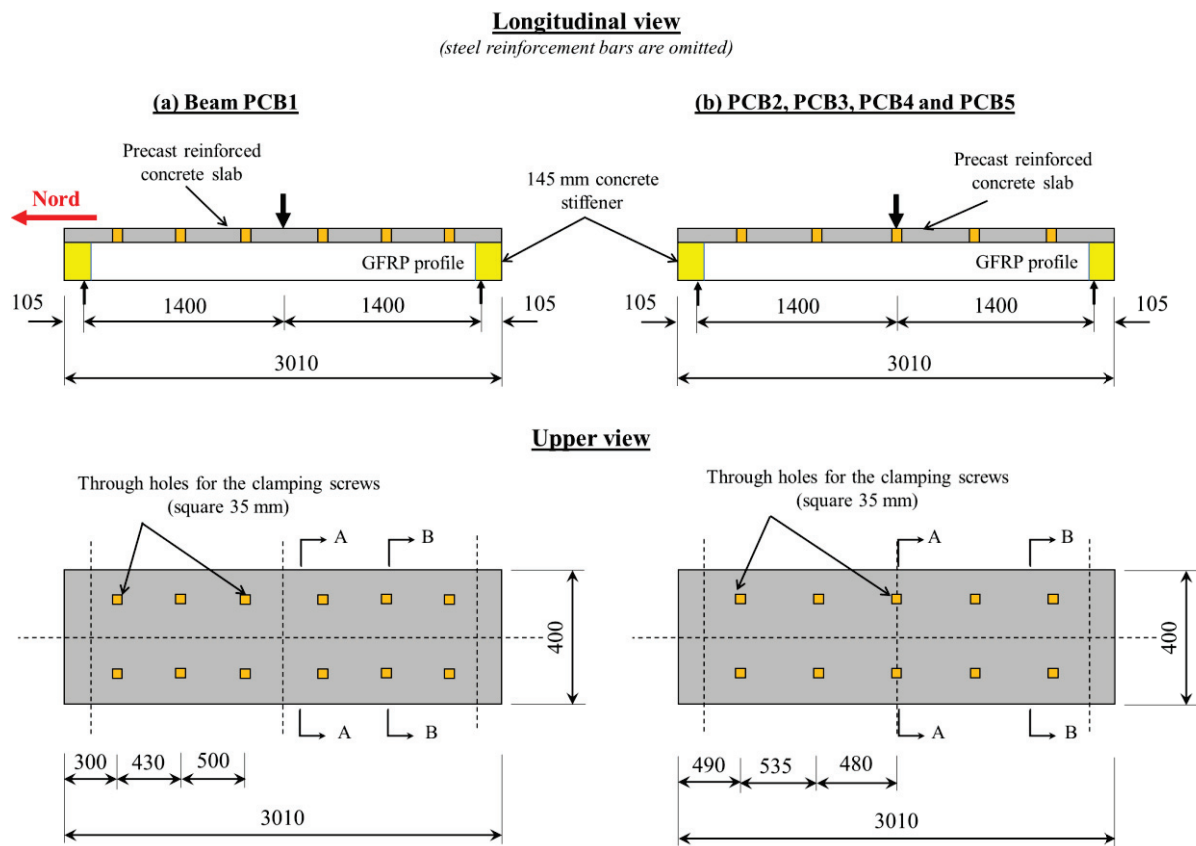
Vues longitudinale et de dessus des poutres mixtes (dimensions en mm)
